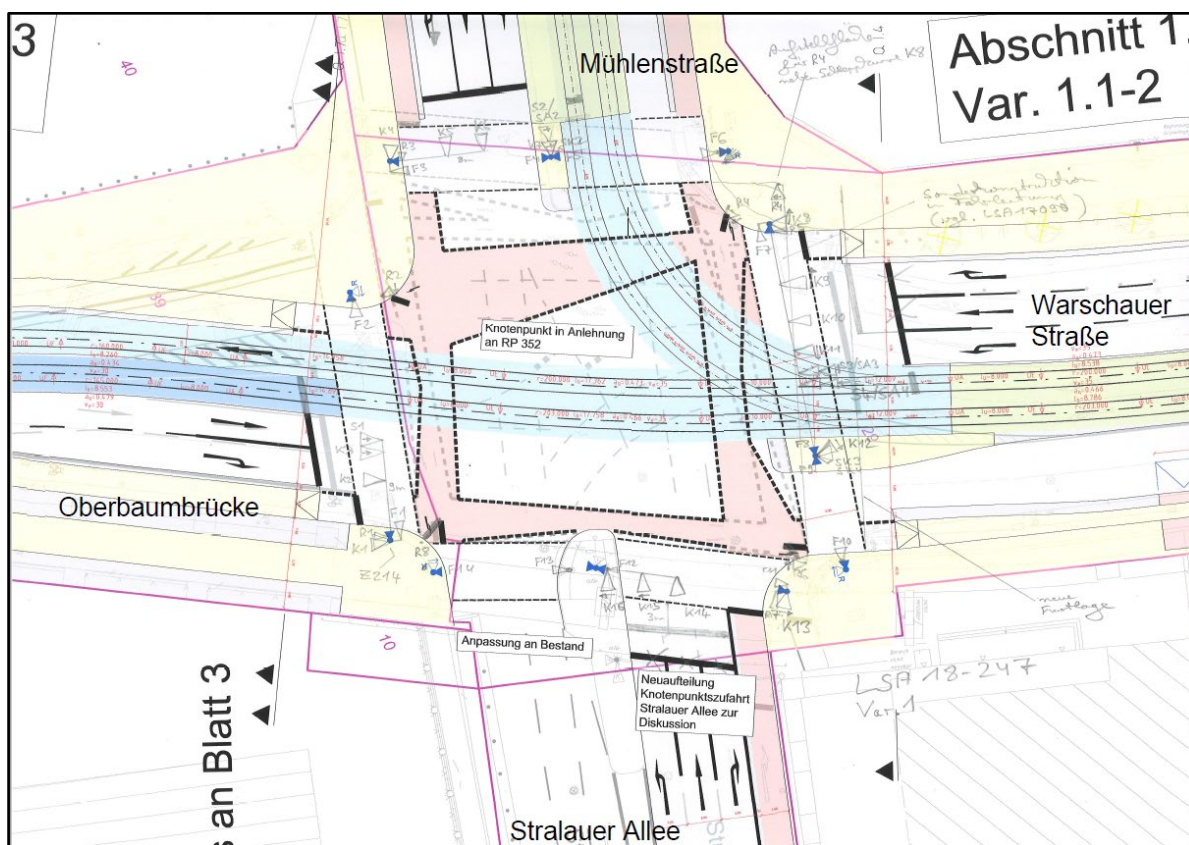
KP Oberbaumbrücke/Mühlenstraße mit Straßenbahn (Stand 02/2026)
